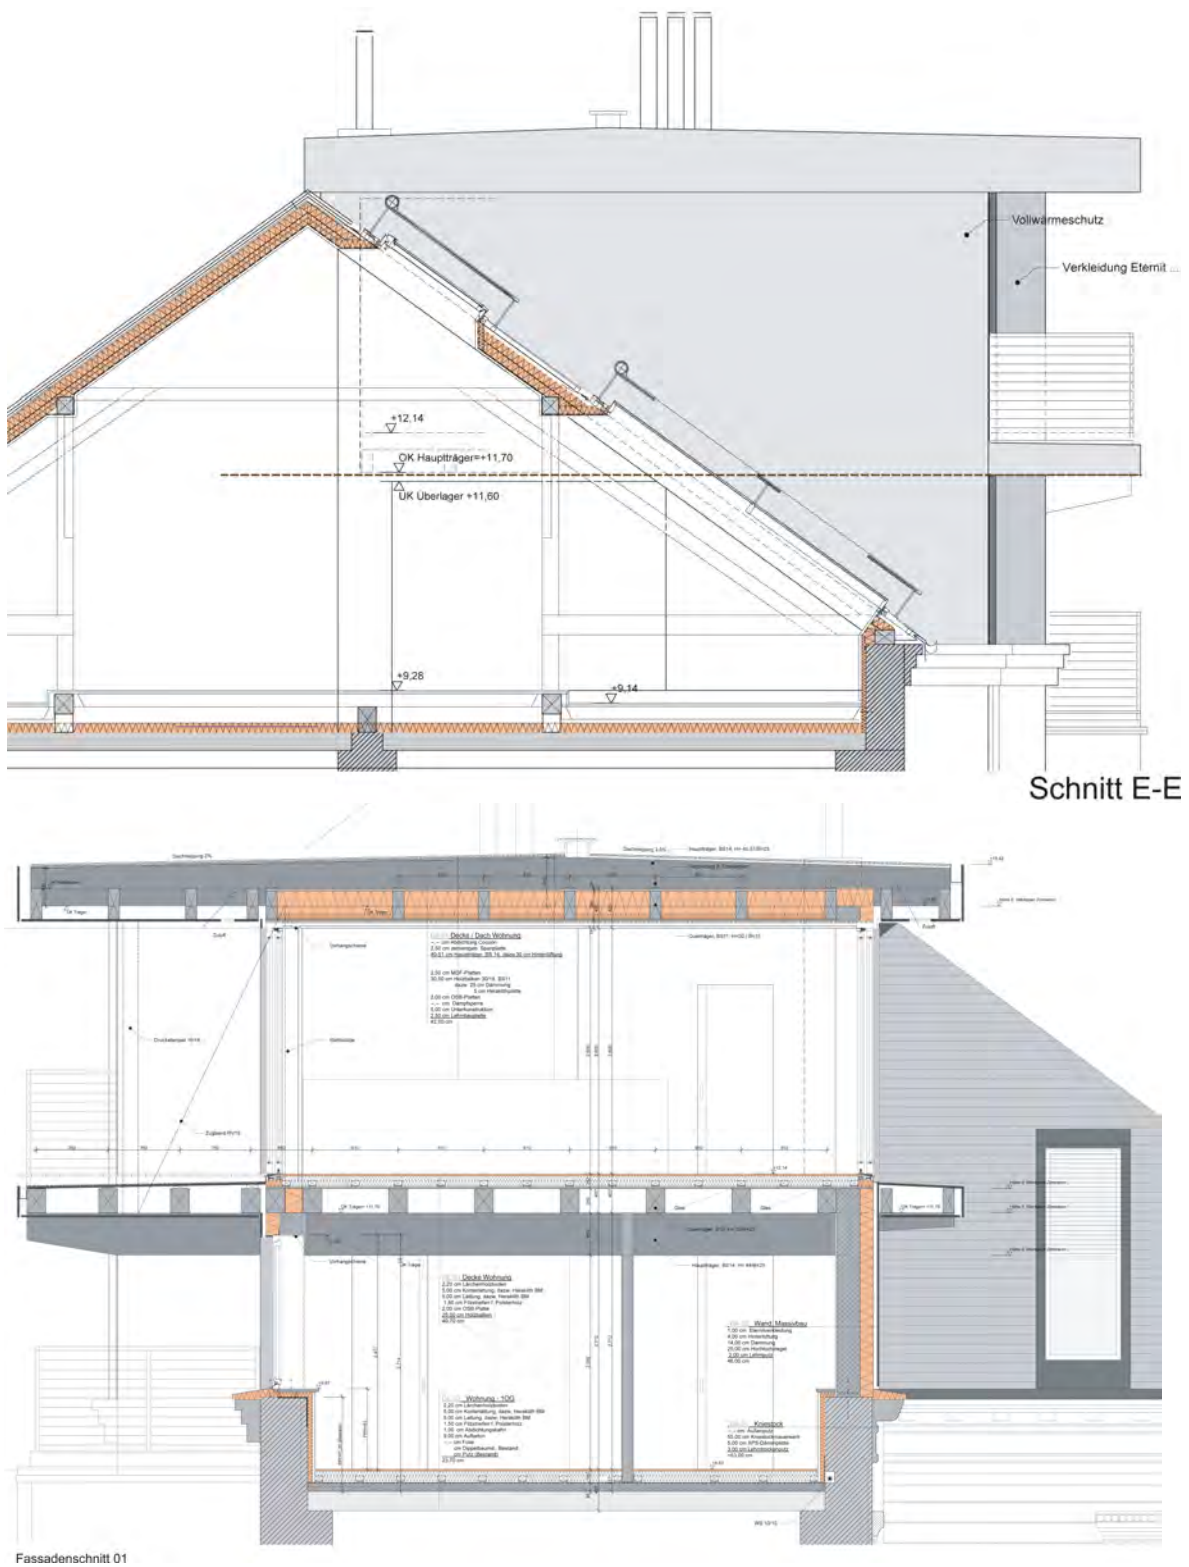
Schnitt E-E und Fassadenschnitt 01
